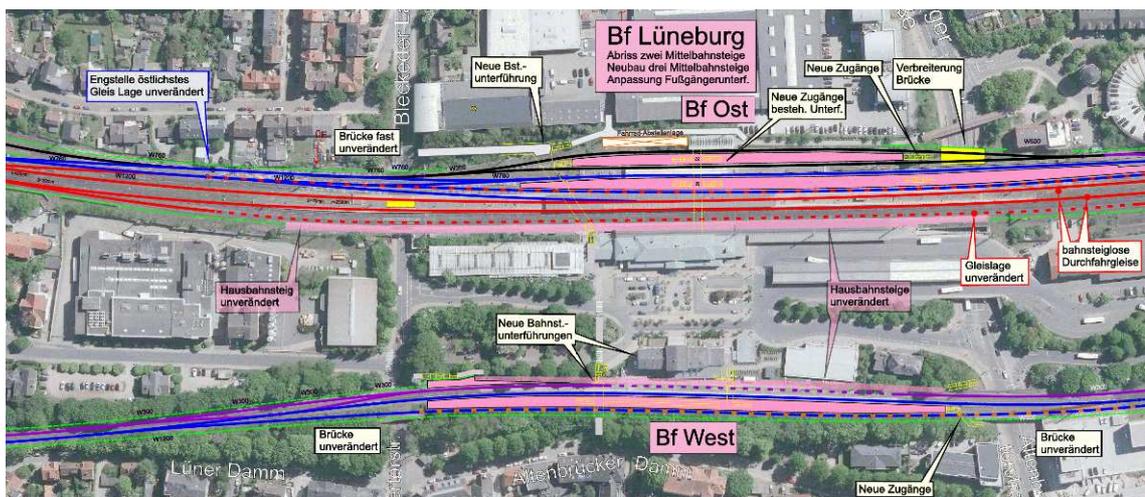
Ausschnitt aus dem Original VR Lageplan für den Bahnhof Lüneburg (April 2020) im Maßstab 1:1.000
